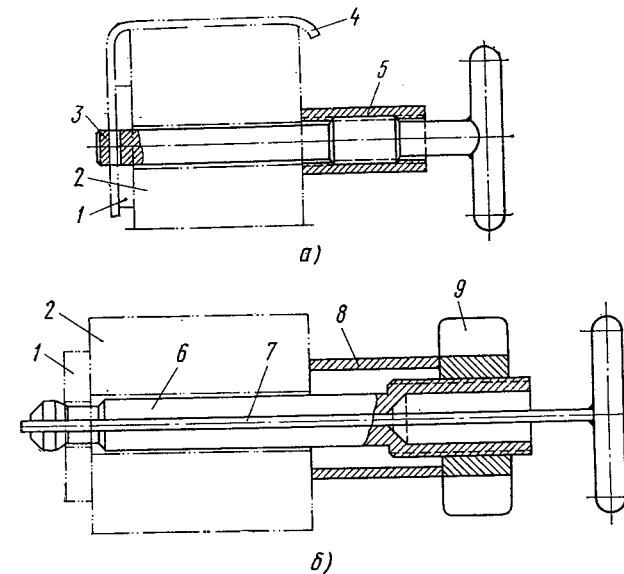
Фиксаторы для крепления закладных деталей с круглым или квадратным отверстием:
